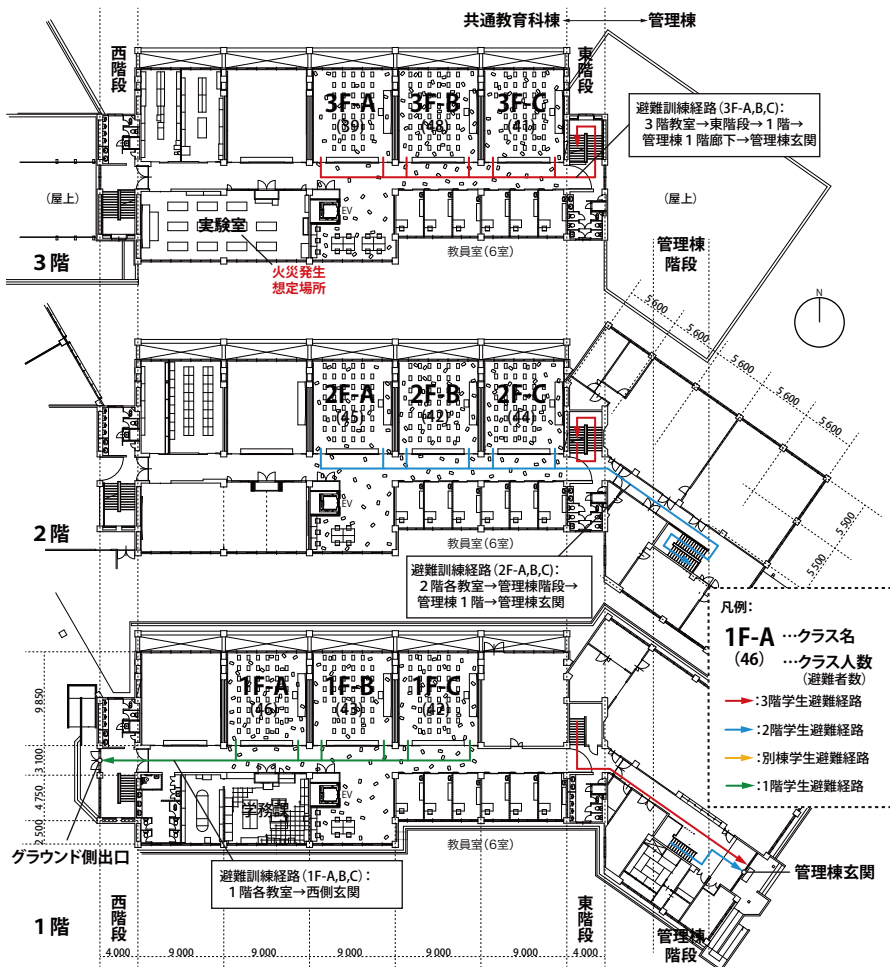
校舎各階平面図と避難訓練時(Sc4)の経路
